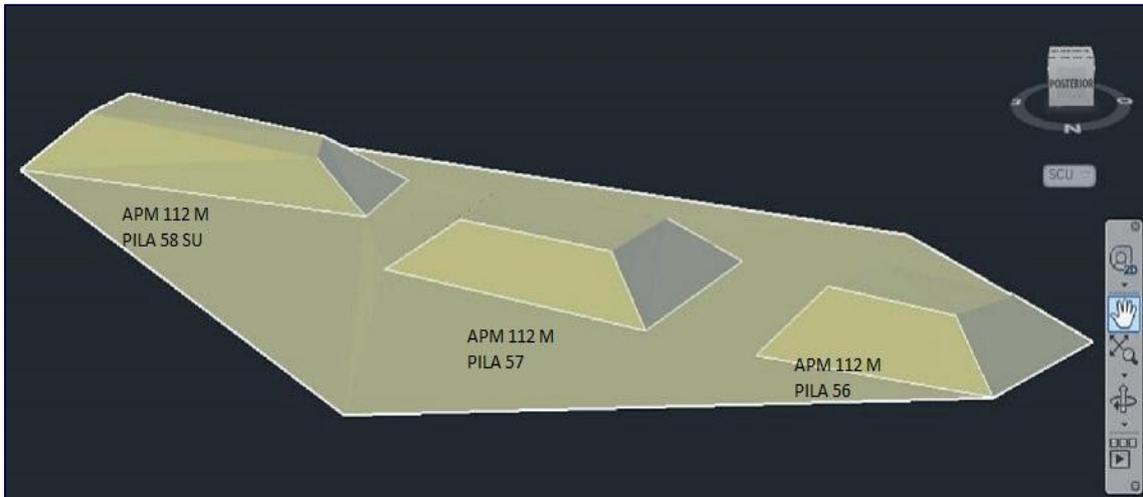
VISTA TRIDIMENCIONAL DE LOS MONTÍCULOS, AUTOCAD CIVIL 3D.
